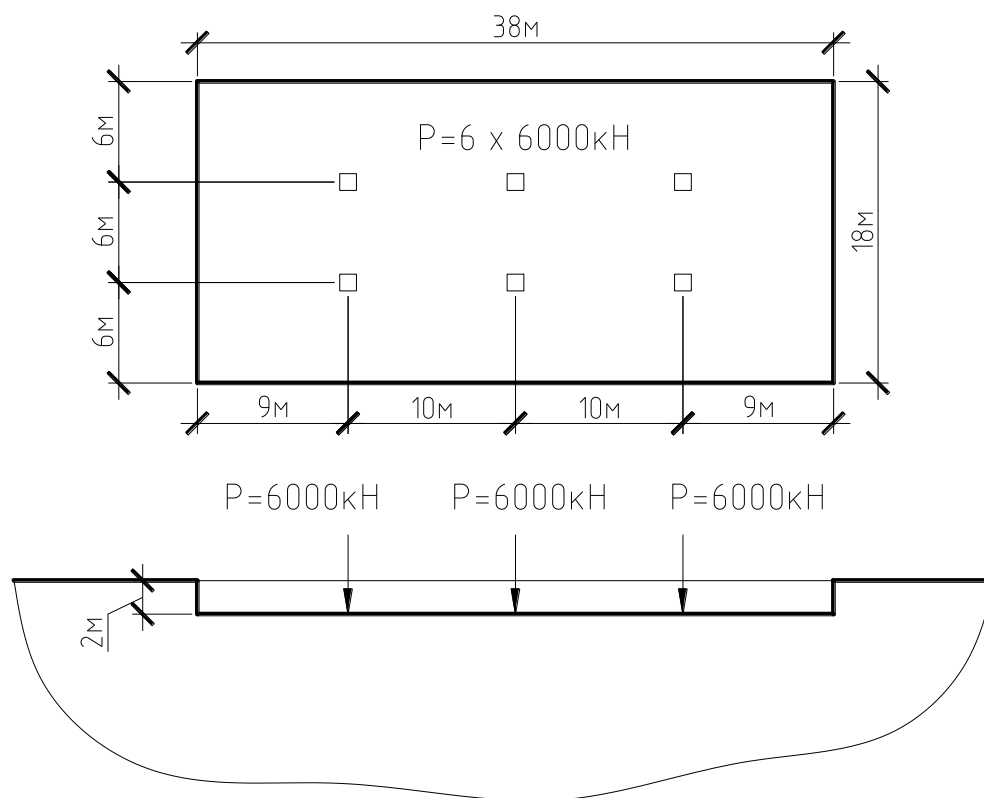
Геометрические размеры и схема загрузки фундаментной плиты
